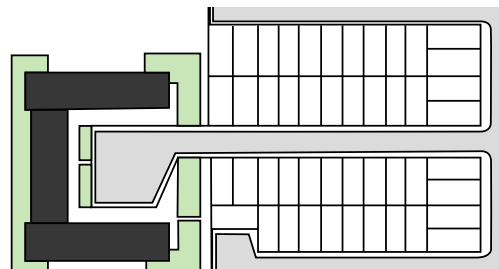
Planta esquemática de retornos tipo "Cul de sac"
